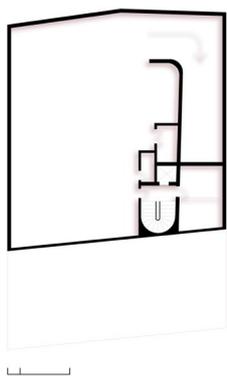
Edifício Condado de Luzerne, pavimento subsolo.
